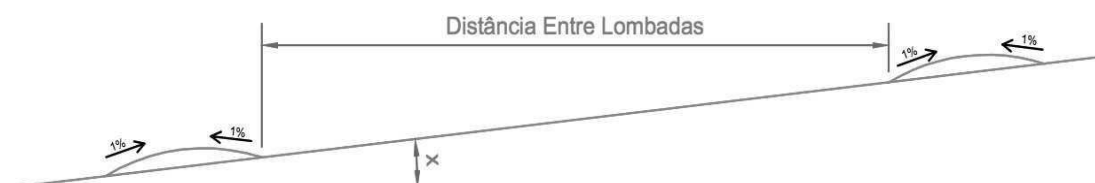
Projeto de Adequação de estradas rurais de Toledo, Paraná – fase de construção de lombadas
